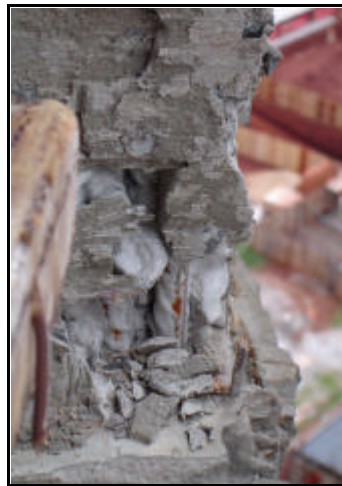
Exemplo típico de nicho de concreto e corrosão de armaduras.
